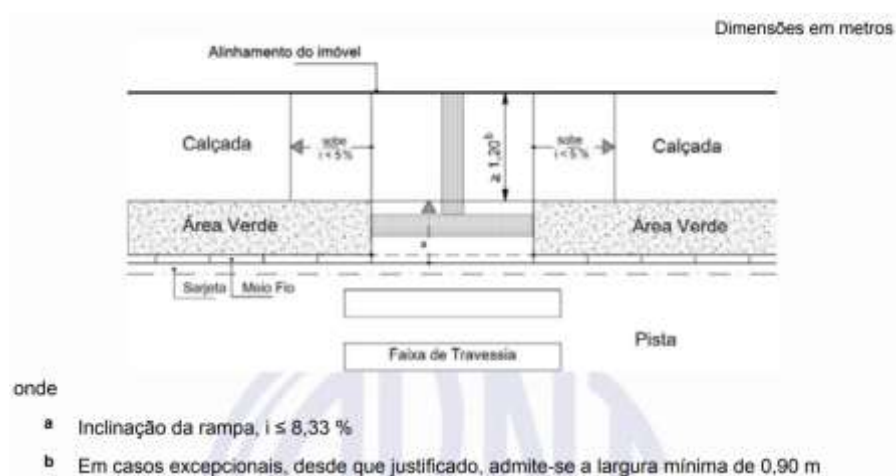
Rebaixamento de calçada entre canteiros – Exemplo.
